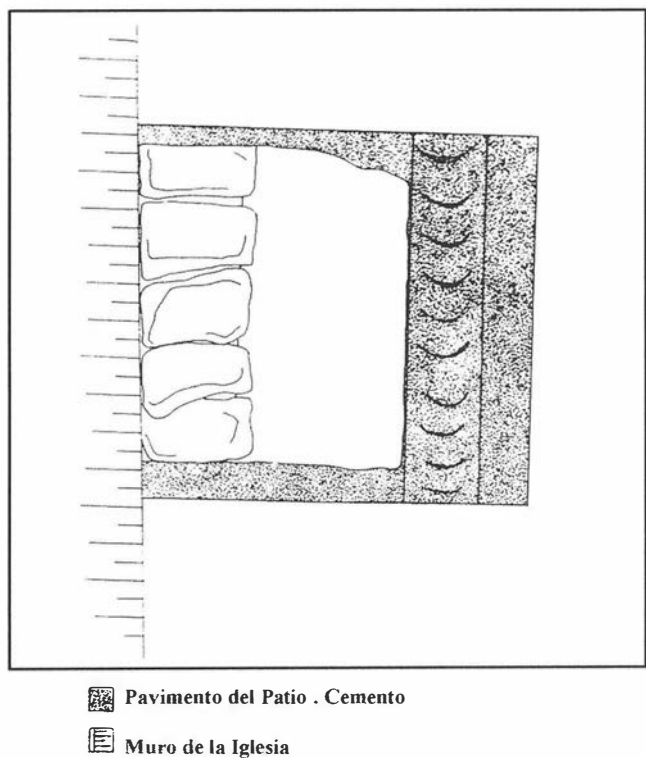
Corte 3. Pavimento de cemento del patio actual y losas que cubren la galería de aireación del muro Oeste de la iglesia
